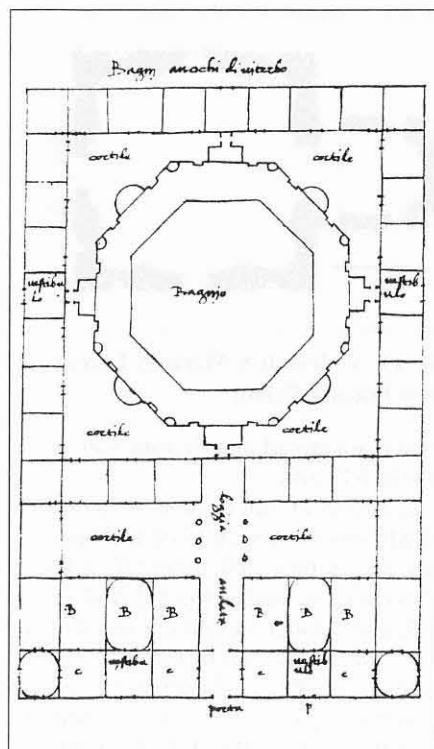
Terme del Bacucco. Pianta di L. Donati
